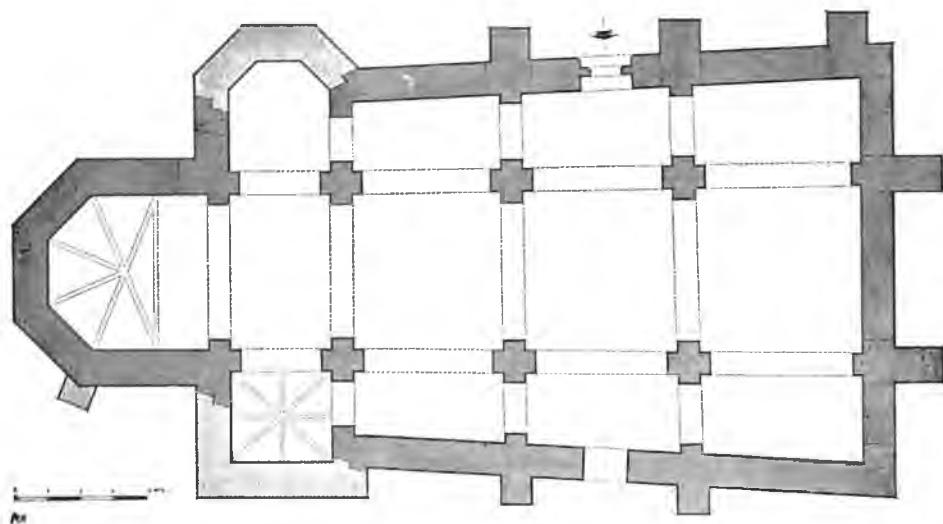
Santuario de Santa María de Musquilda, en Ochagavia; planta y sección.
